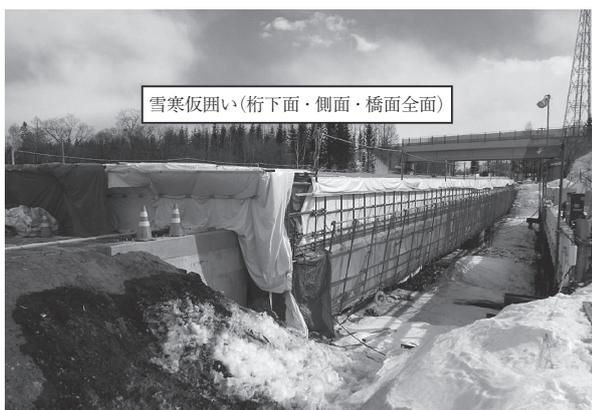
雪寒仮囲い（調整コンクリート施工時）
